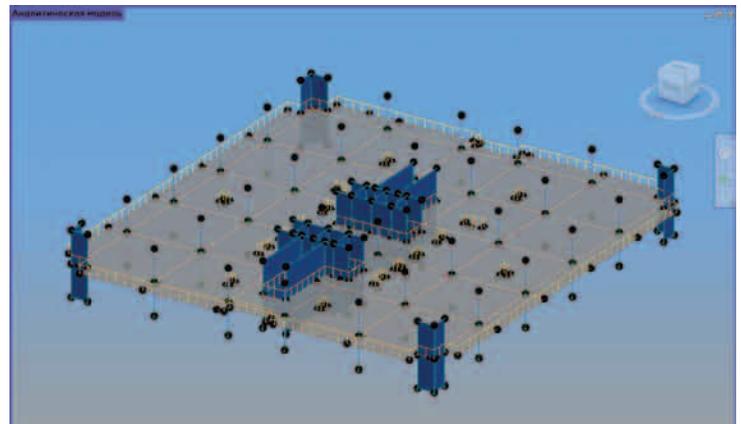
Аналитическая модель постнатянутого перекрытия в Revit
